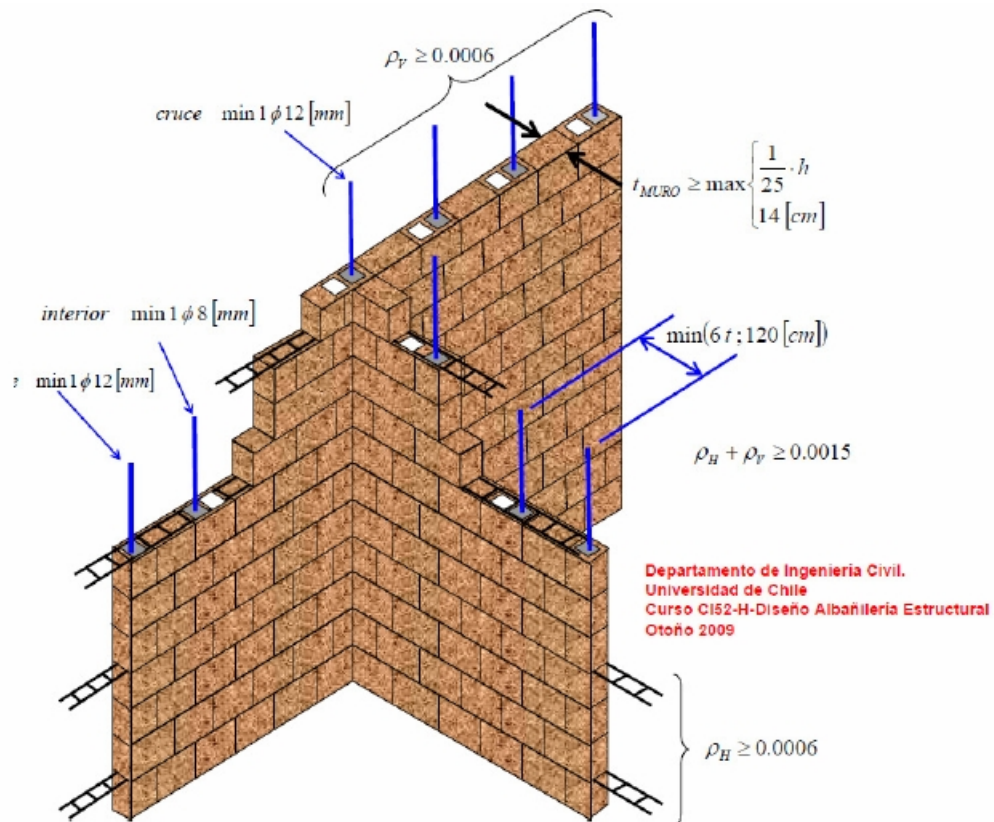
Detalle las barras verticales de refuerzo (Astroza, 2008)
